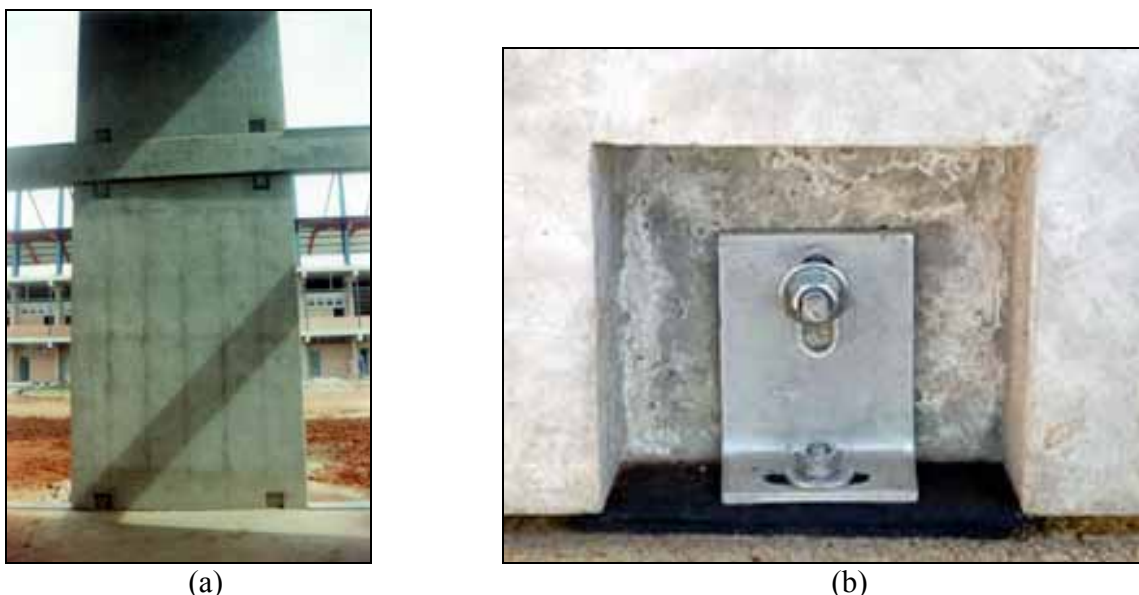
(a) vista posterior do painel sanduíche com as quatro fixações do painel nas vigas e (b) rebaixo no painel para a fixação com a estrutura.
